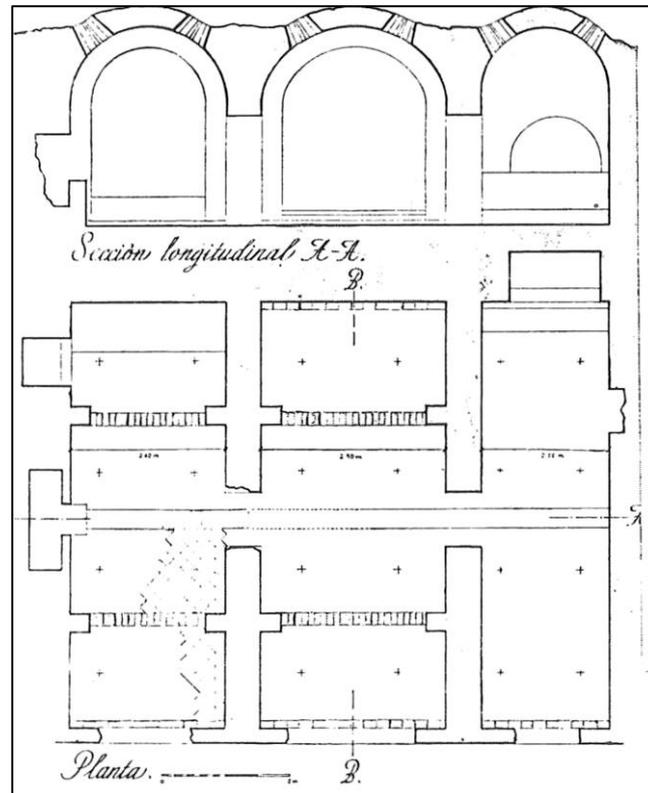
Plan et section longitudinal du bain torres torres. Source TORRES BALBAS³¹⁹
